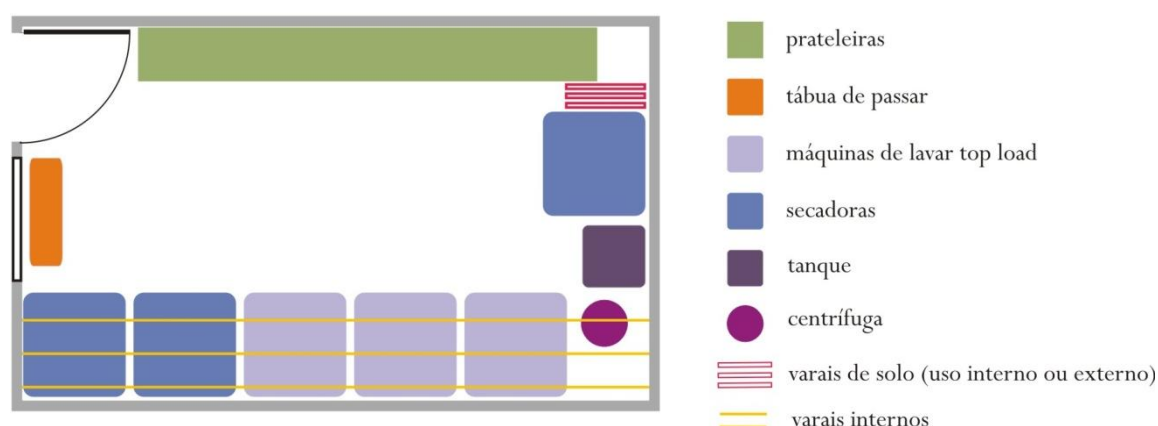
Edifício Solar da Serra - planta baixa da lavanderia coletiva
